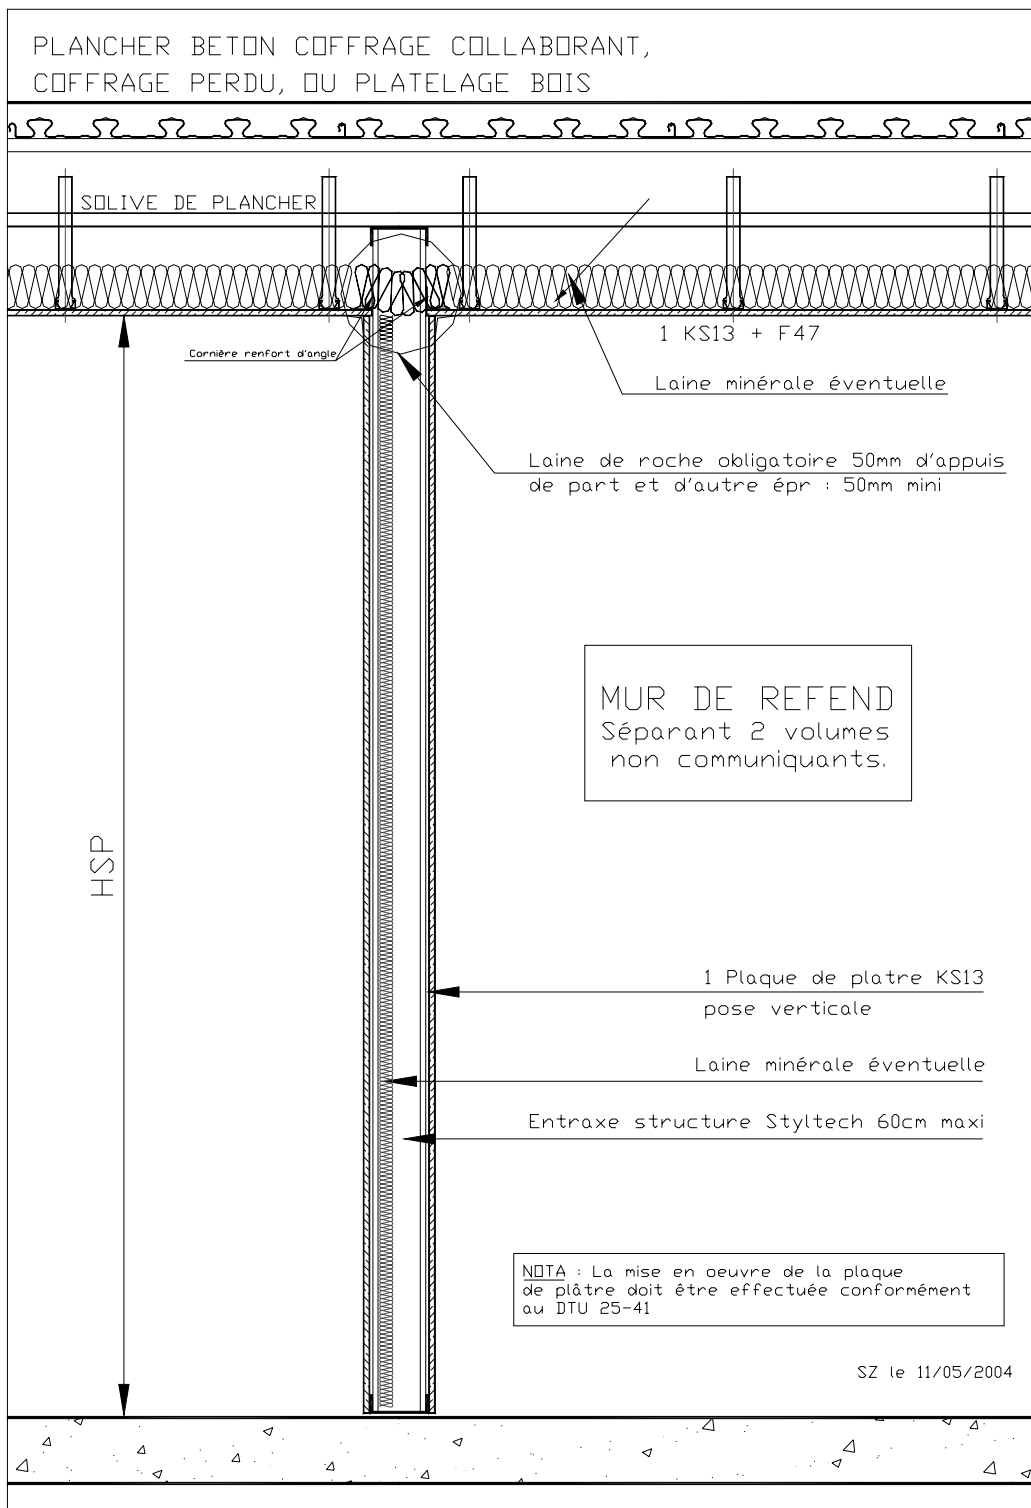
Plancher béton coffrage collaborant, coffrage perdu ou platelage bois
